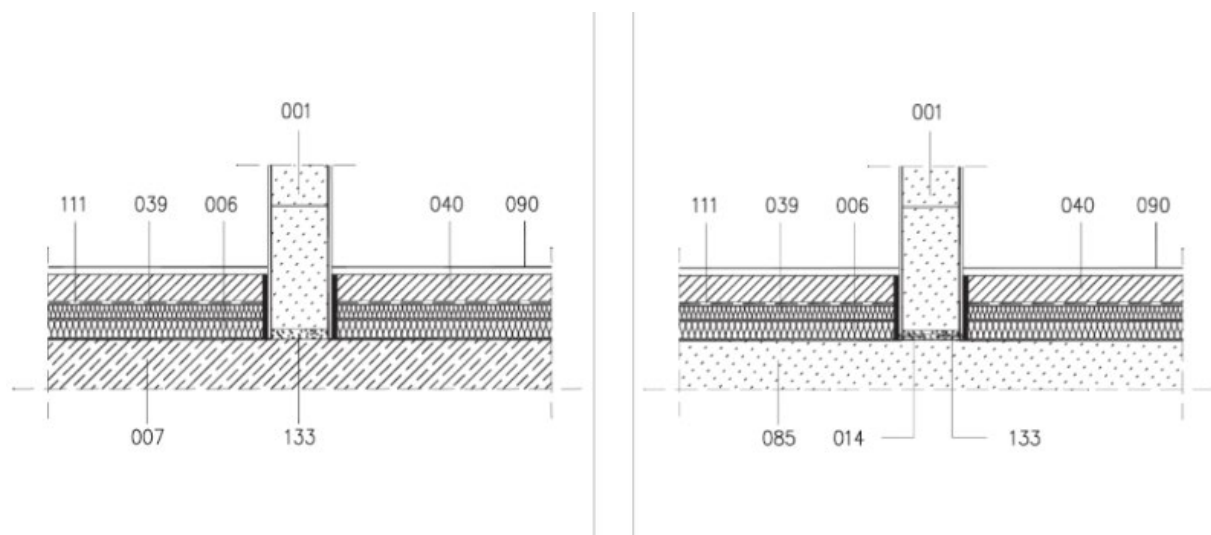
Конструкція бетонного перекриття між поверхами
